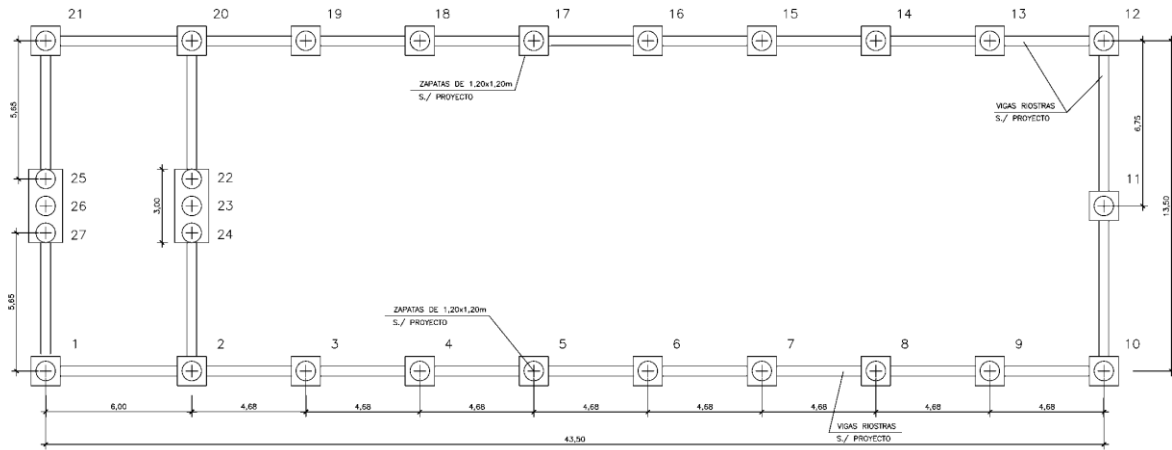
Planta fundaciones nave industrial en Loeches (Madrid)
